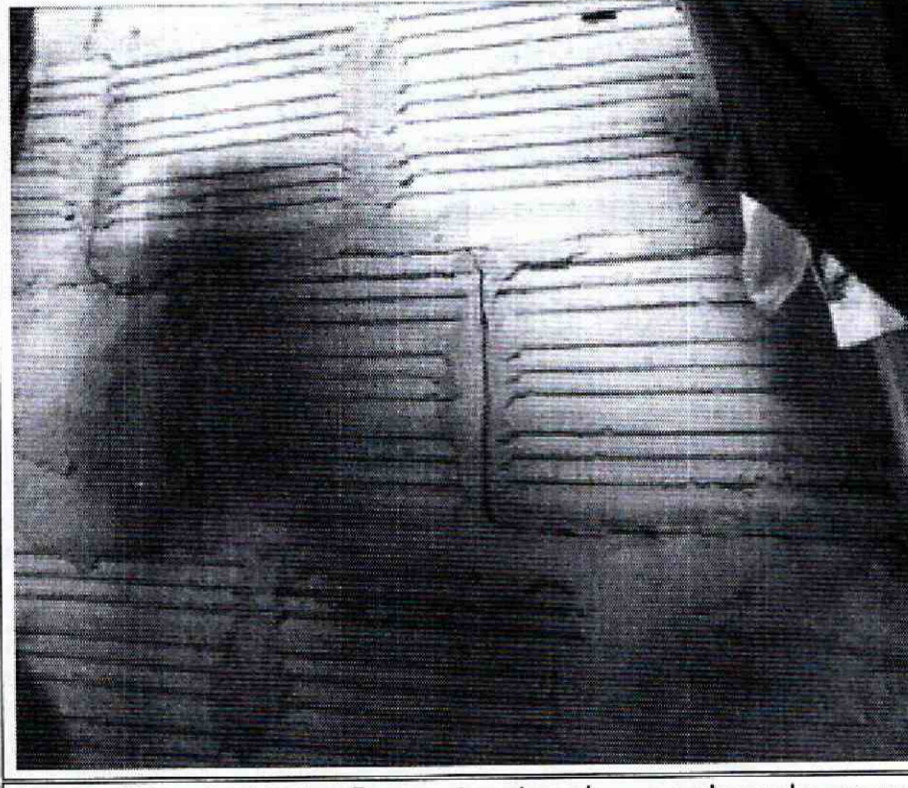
Vista fisura tendencia escalonada muro costado sur del predio de la Transversal 20 D Bis A No. 68 K - 36 Sur
